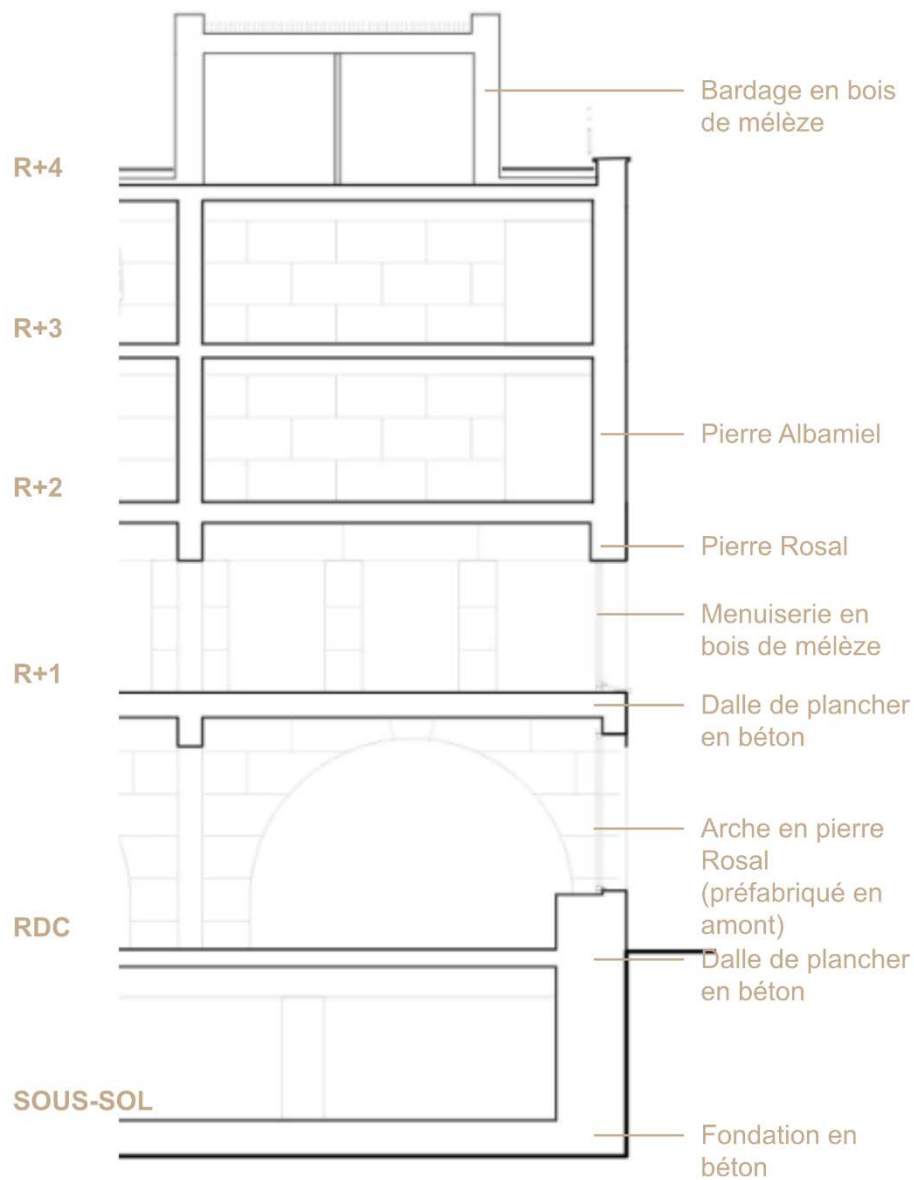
Coupe longitudinale du projet de l'immeuble mixte signé Gilles Perraudin. © AAP
